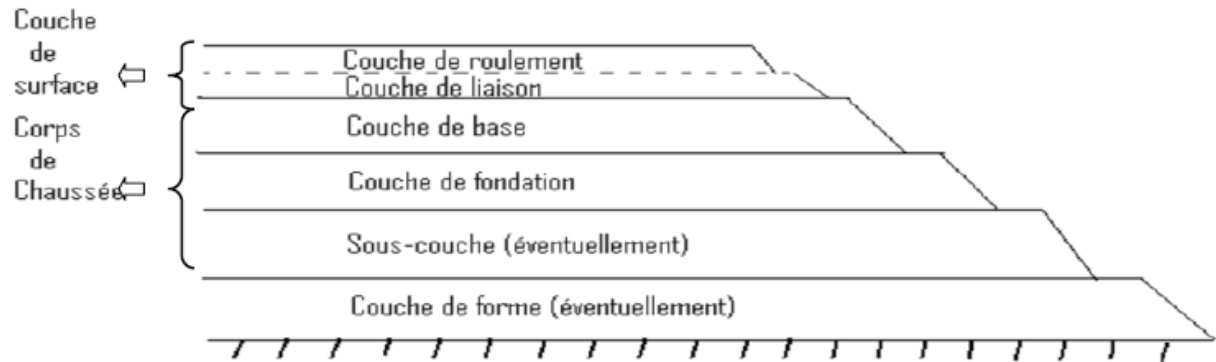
Coupe type montrant les différentes couches d'une chaussée routière (LCPC, SETRA, 1998).
